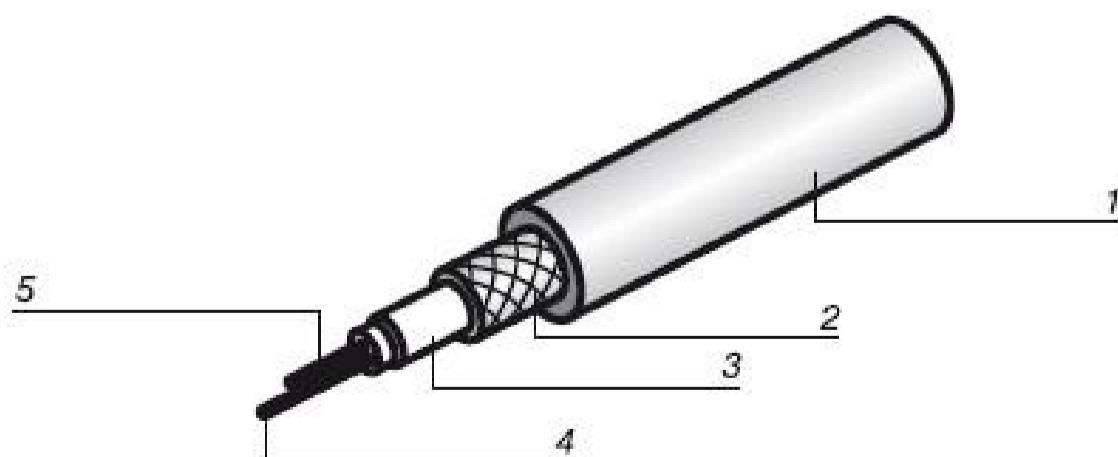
Структура двухжильного нагревательного кабеля: 1 – оболочка; 2 – экранирующая оплетка; 3 – двухслойная изоляция; 4 – нагревательная жила
